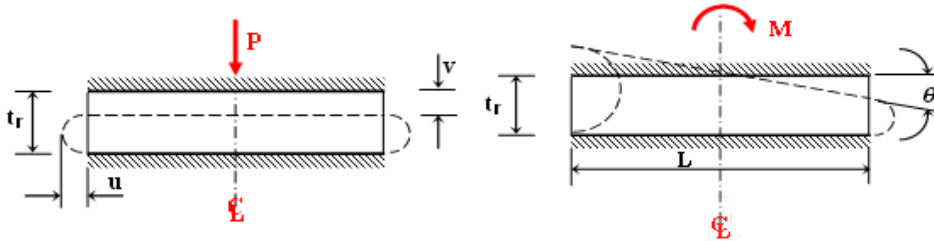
Cargas, desplazamientos y giro actuando en un aislador.
